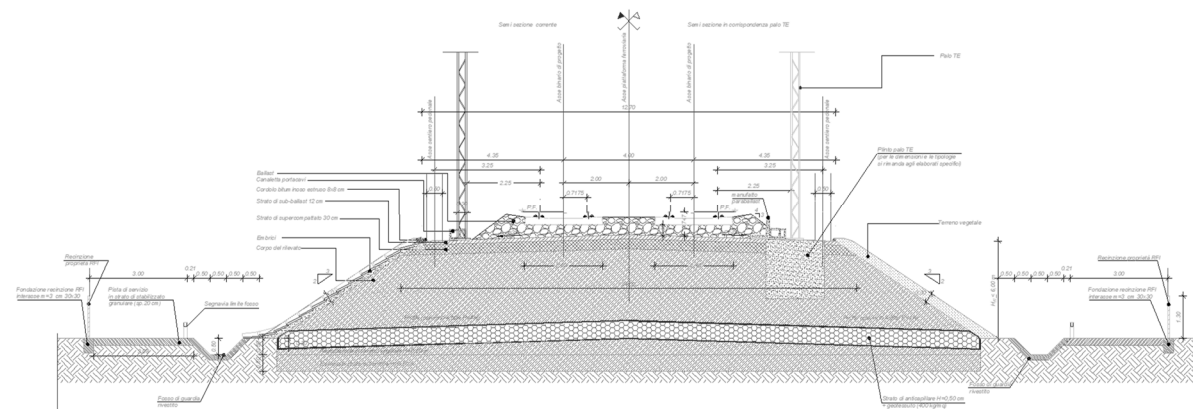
Sezione tipo ferroviaria in rilevato a doppio binario (piattaforma in retto)
